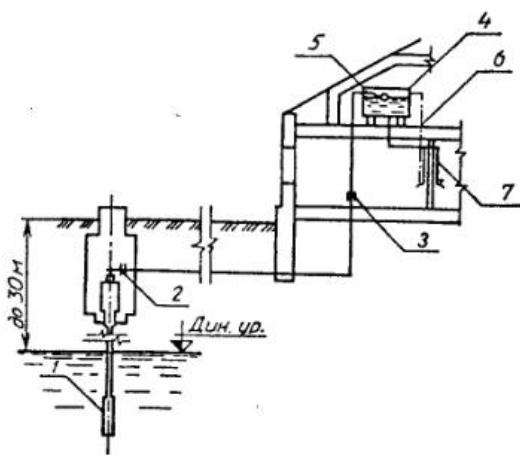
Схема подачи воды в жилой дом: 1 — водозаборная скважина с электронасосом; 2 — обратный клапан; 3 — вентиль; 4 — напорно-регулирующий бак; 5 — поплавковый клапан; 6 — переливная труба; 7 — разводящая сеть.
